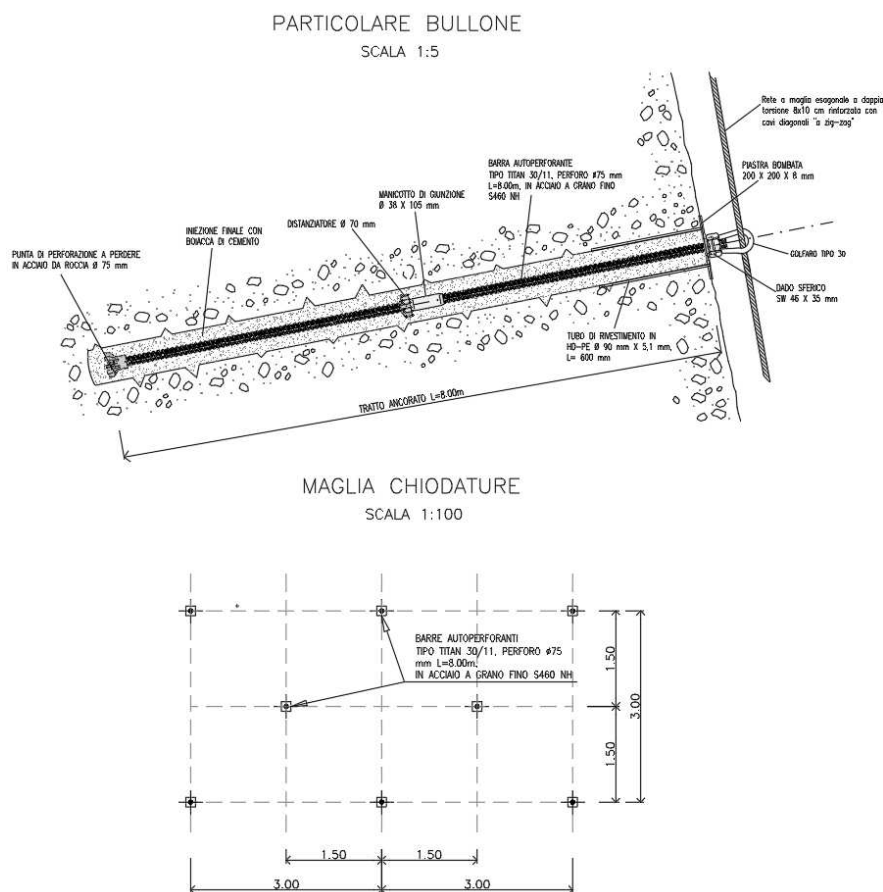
Imbocco Nord galleria Muslone: intervento con chiodatura e rete metallica, particolari.
